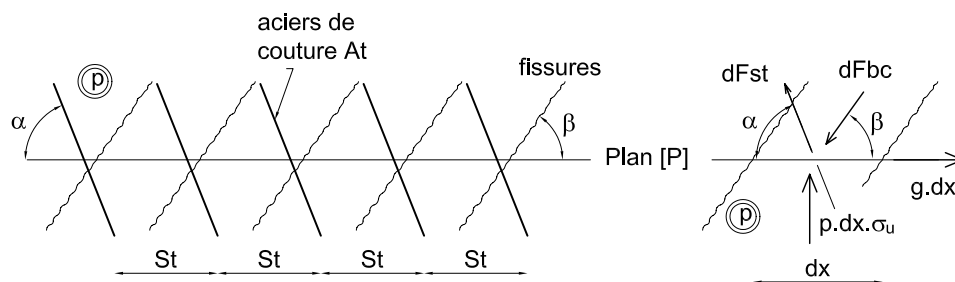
Equilibre d'une surface élémentaire du plan $[P]$.
